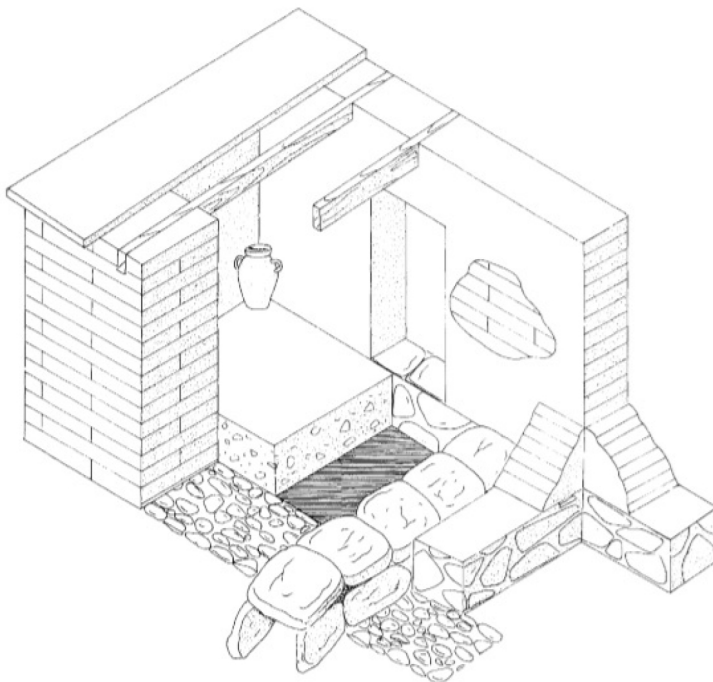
Reconstrucción de sistema constructivo en Cancho Roano. Obsérvese el uso de las canalizaciones recubiertas de placas de piedra como basamentos de bancos corridos en la habitación. Celestino *et al.*, 2015: fig. 3).
